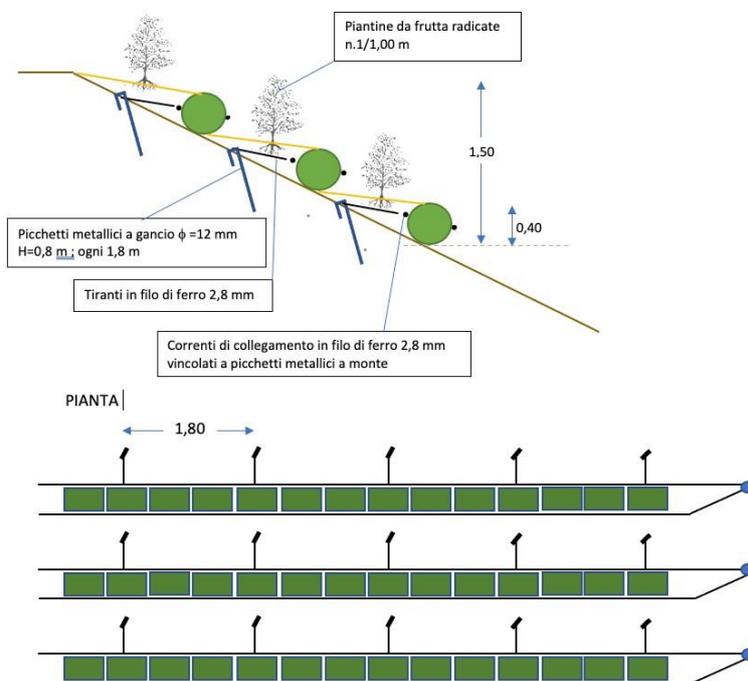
Schema di sezione tipo e pianta prototipo B2.
